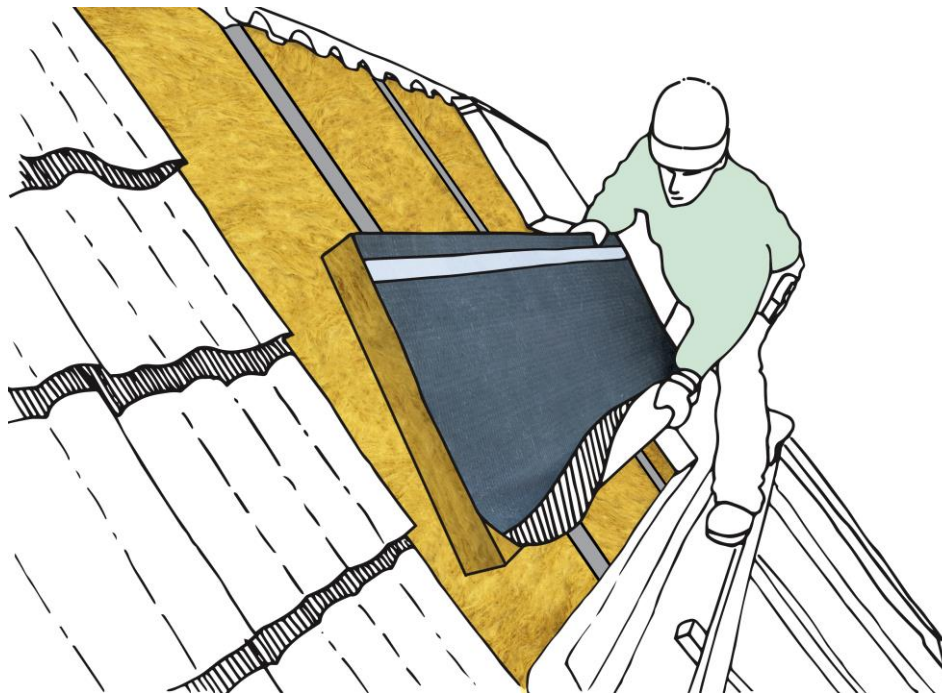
Bei einer Aufsparrendämmung wird Mineralwolle (Steinwolle oder Glaswolle) durch einen Fachmann auf dem Dach angebracht.
